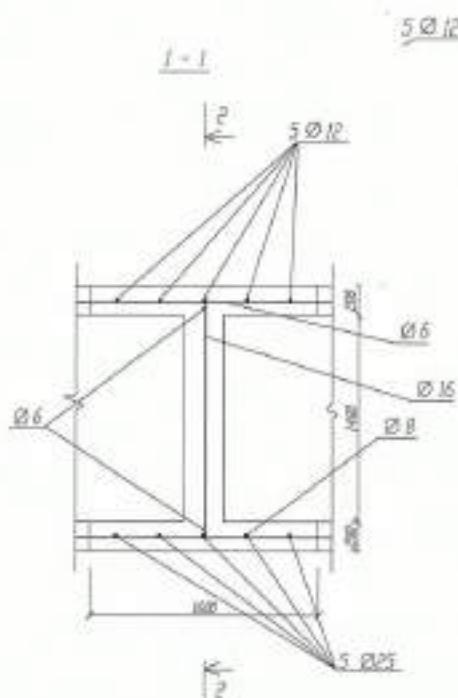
Схема армирования фундамента на участке между осями Б-Г и Ж-К
